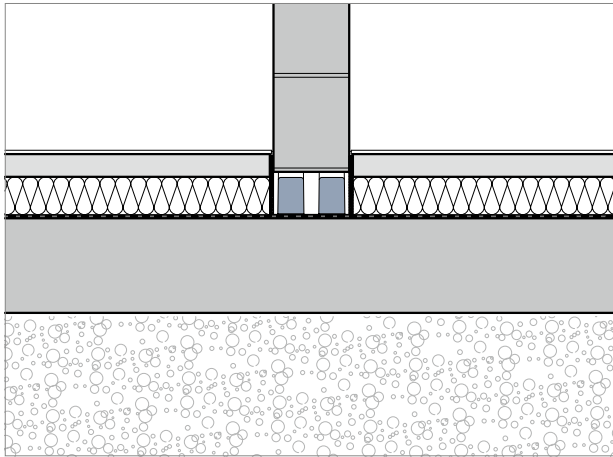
Schöck Sconnex® Typ M Innenwand auf Gründungsbauteil
